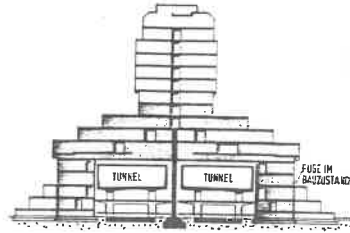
Querschnitt der Straßenüberbauung SAB Berlin.
